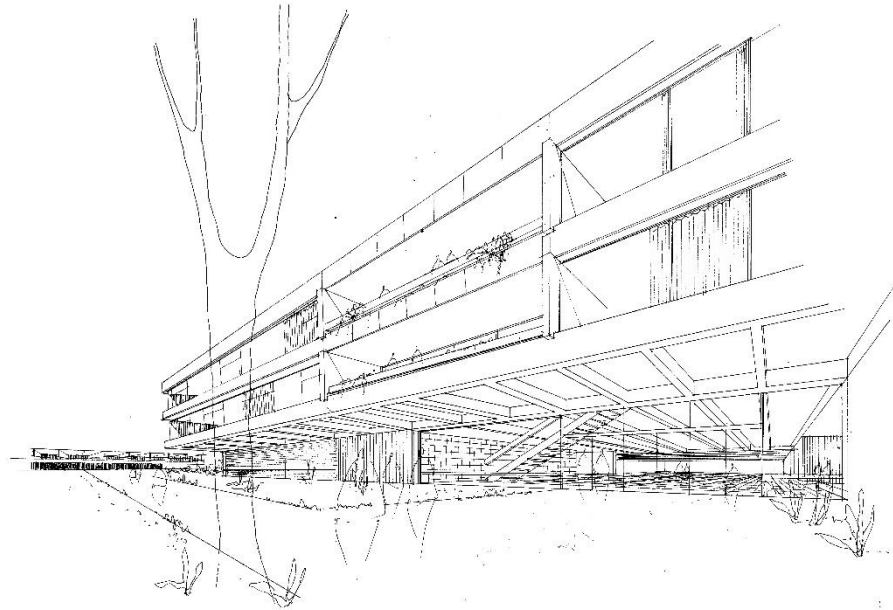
Primera versión de la vista exterior de la Fundación Calouste Gulbenkian
